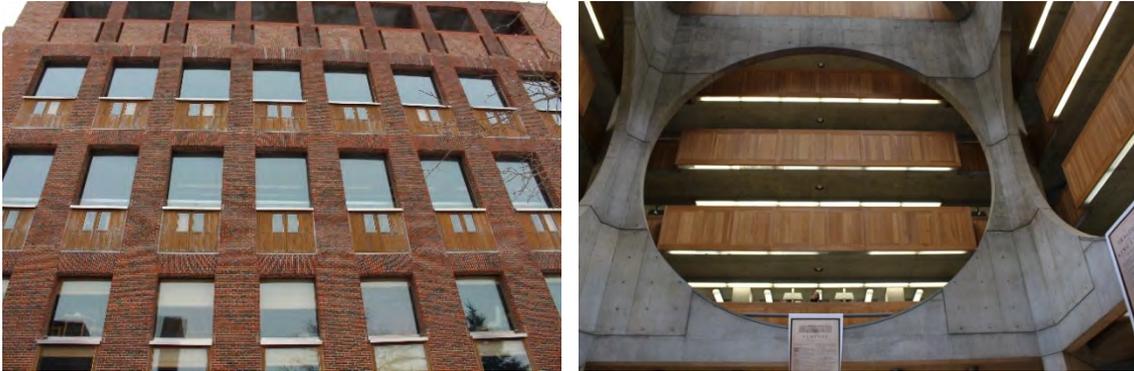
e 59 | Detalhe da pingadeira do painel e da estrutura tratada como sistema de peças encaixadas, cada viga e pilar tem a sua unidade ressaltada [fotos do autor]
